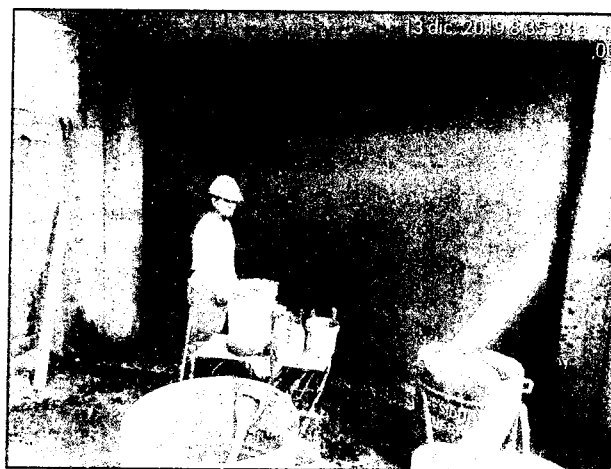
y 12: Vista de los Trabajos realizados en area de Tanque elevado, instalación de tuberías eléctricas, tarrajeo interior
